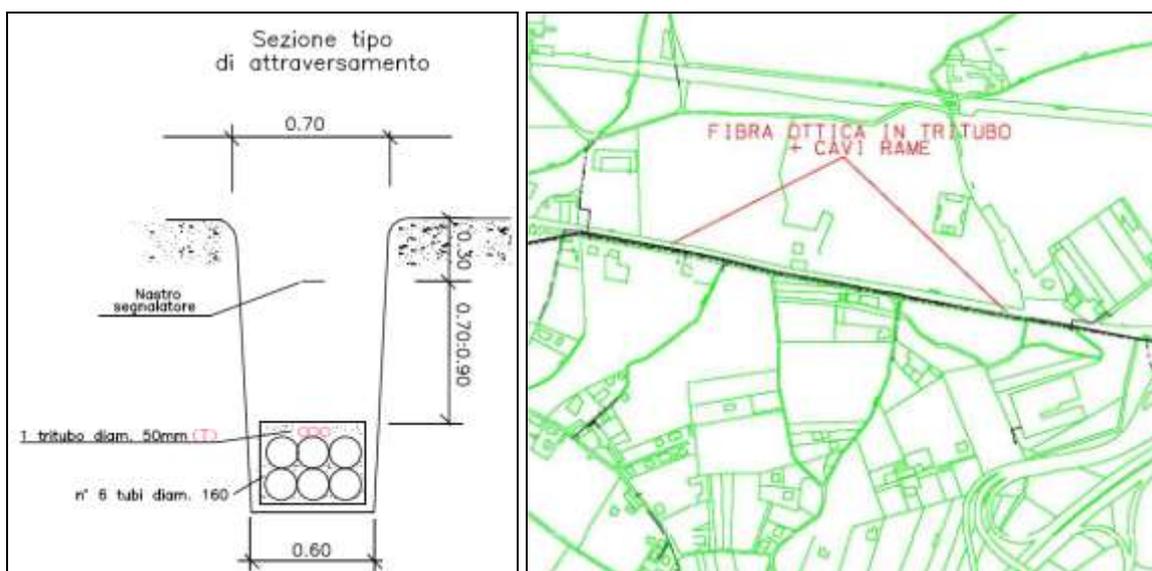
Sezione tipo di attraversamento e planimetria sottoservizi Telecom
